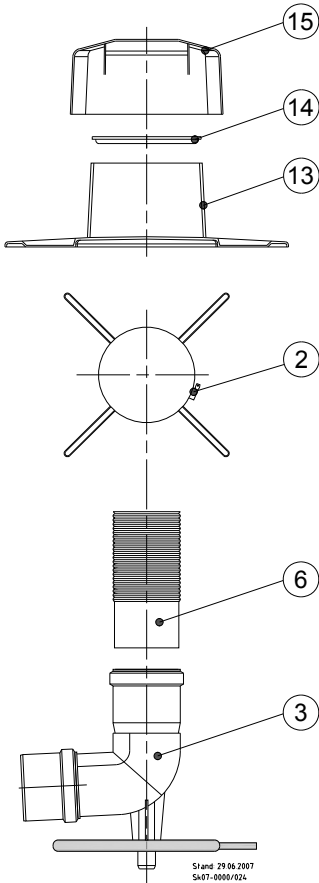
Detail-Zeichnung Befestigung Schachtabdeckung
